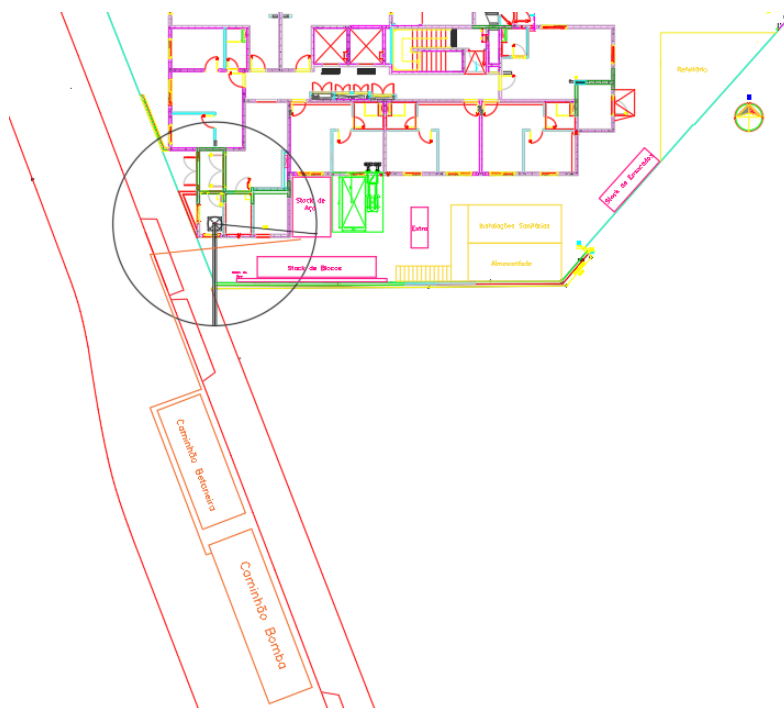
Planeamento da betonagem das lajes (Arquivo pessoal).
